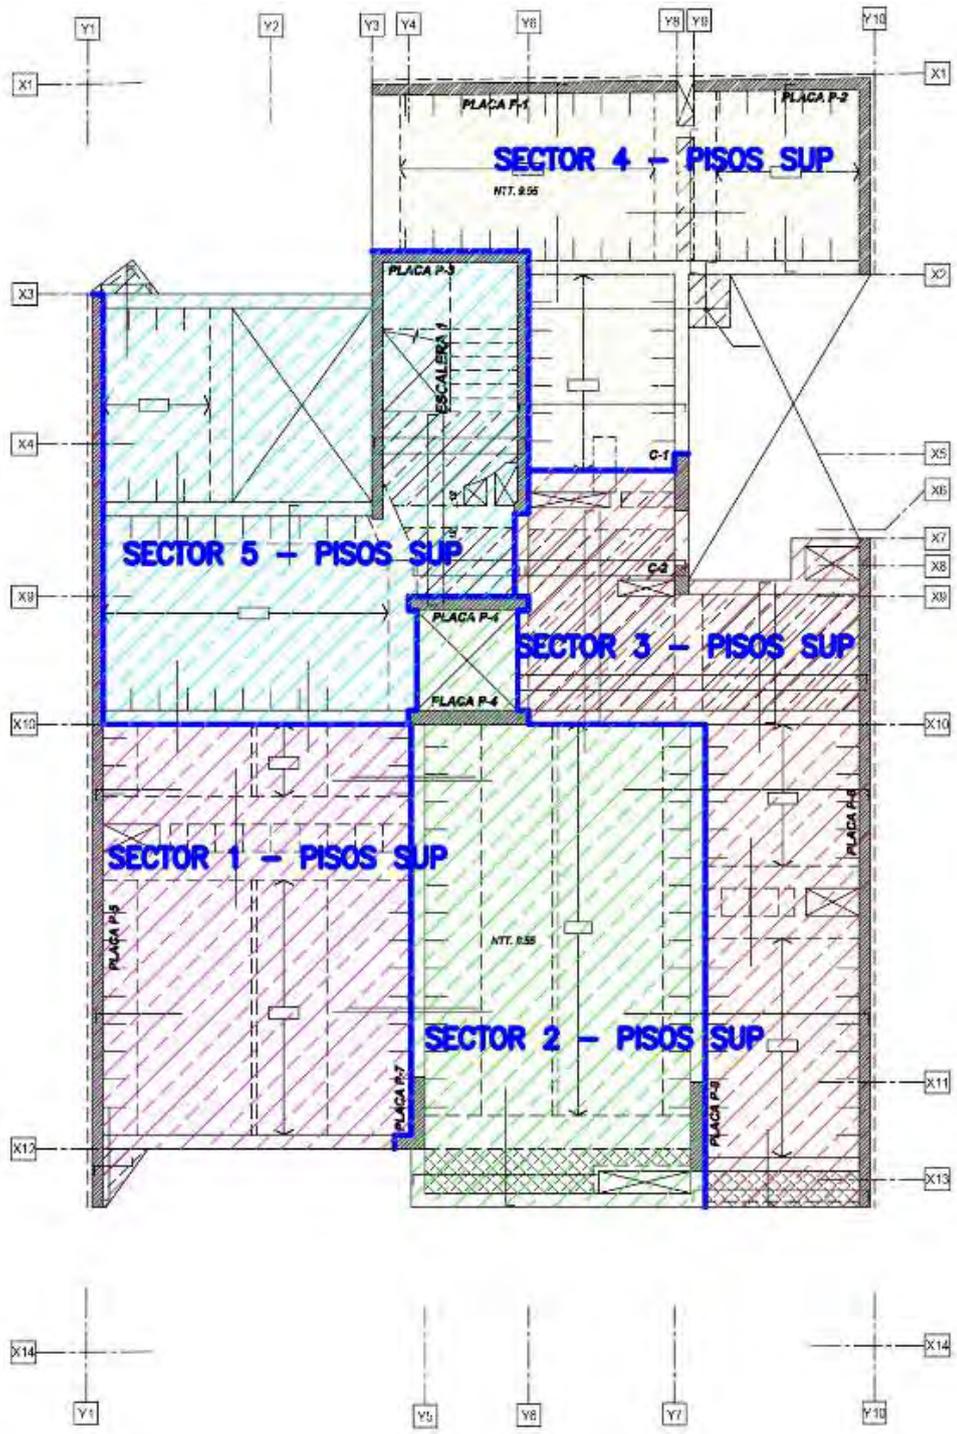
Sectorización desde el encofrado del piso 1 hasta el piso 9 para la construcción del proyecto.
